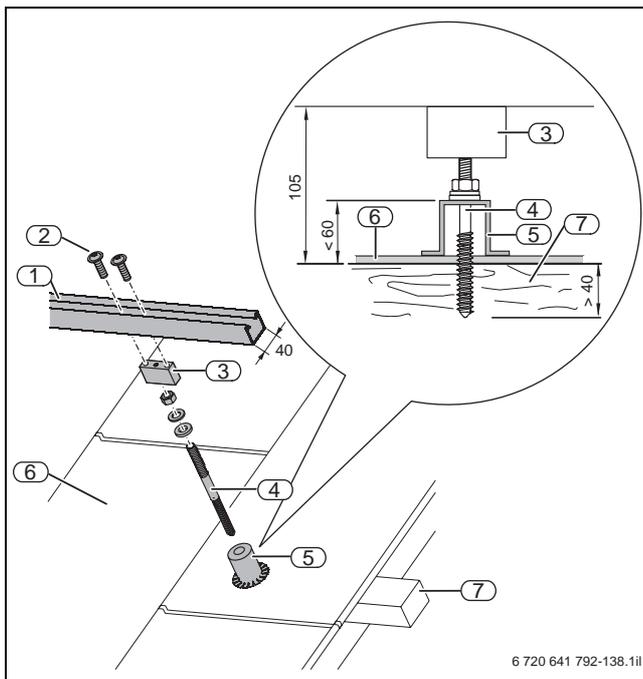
Fissaggio a carico del committente di boccole per il fissaggio a tenuta delle viti prigioniera in caso di montaggio sopra tetto su una copertura in lamiera (misure in mm)
